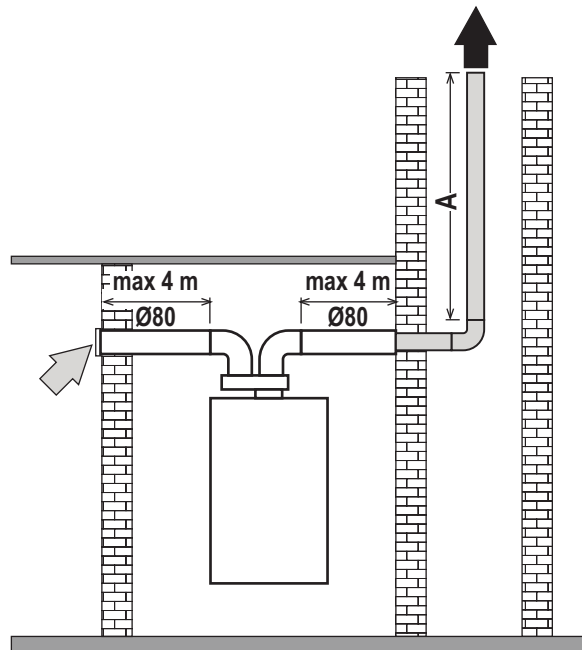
Schema nur Abluftführung mit flexiblem Rohr
